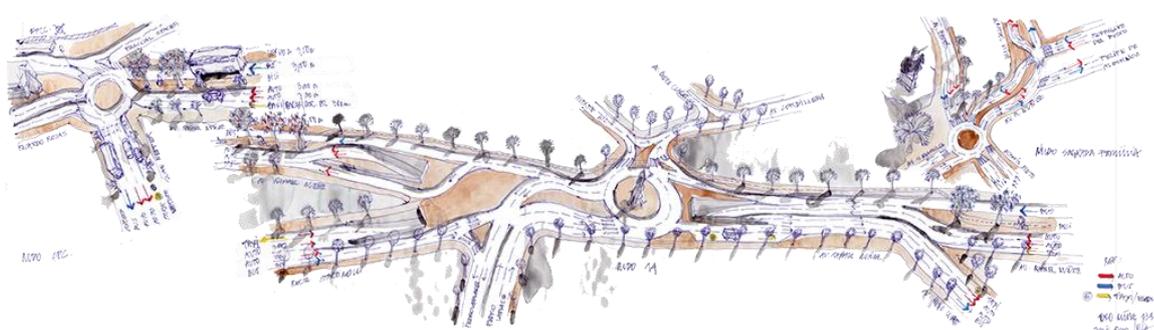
Plano Perfiles - Propuesta Integral | Calles y Avenidas - Sección transversal
